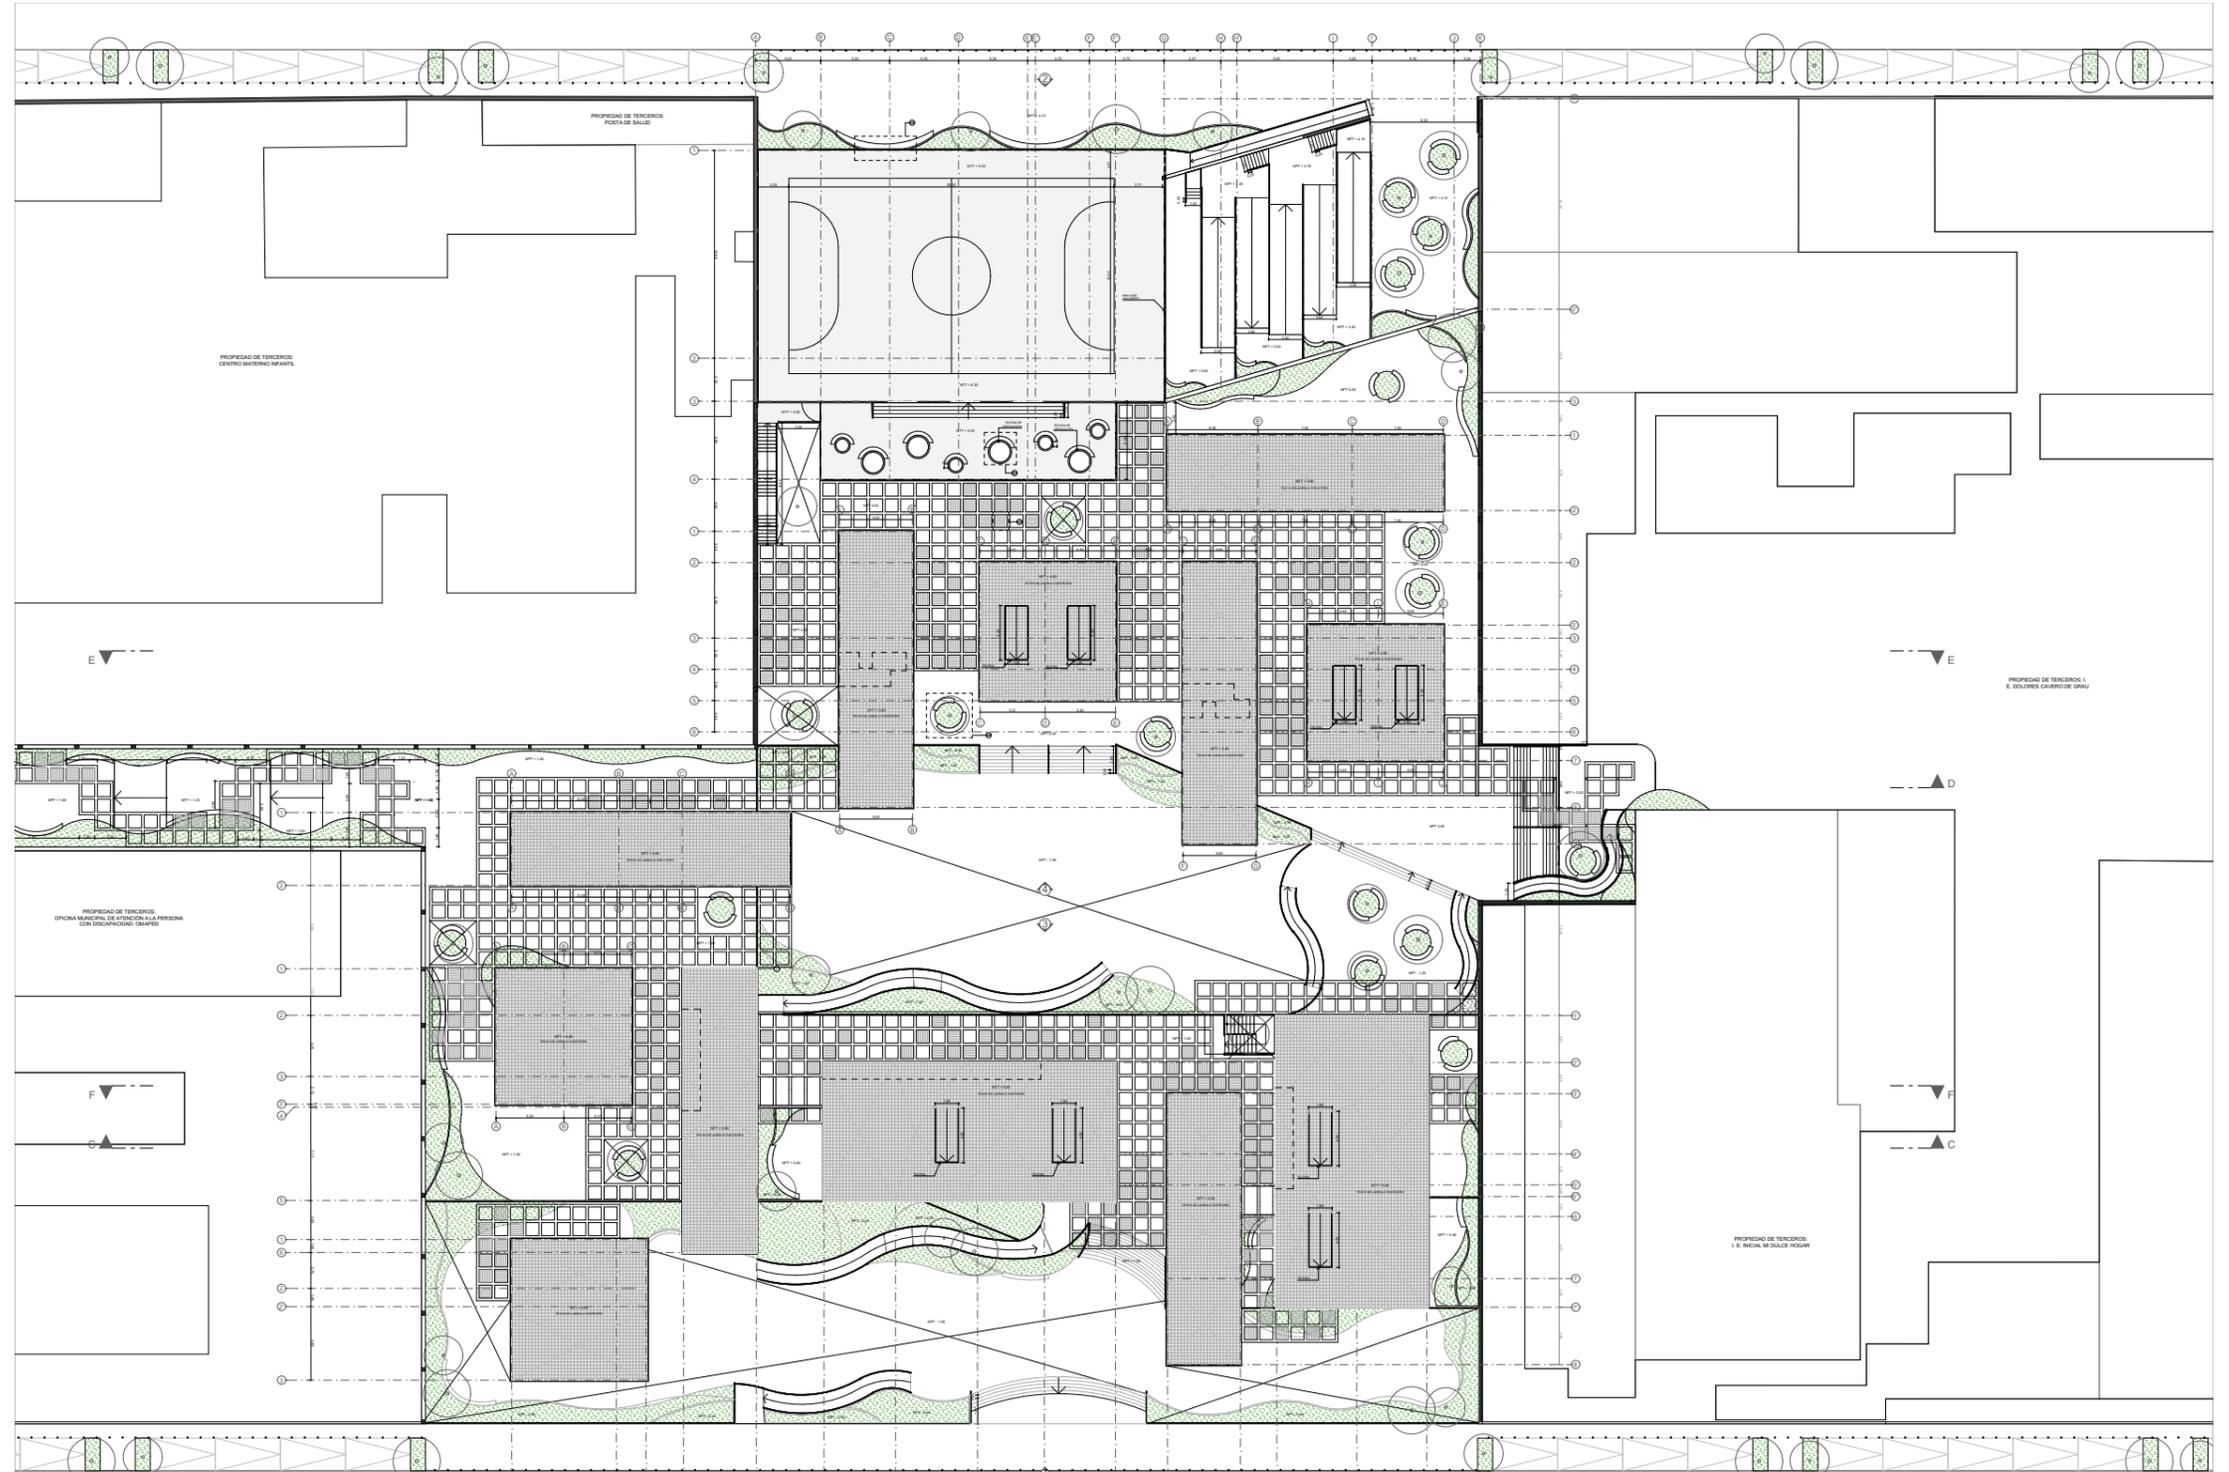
Planta Final Nivel 1. Fuente: Elaboración propia.
